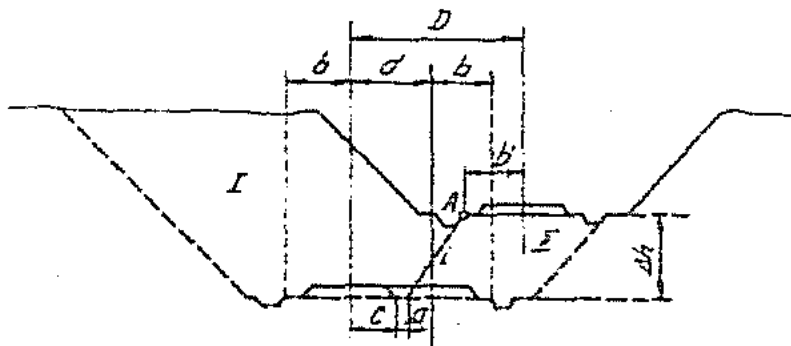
Dublarea liniei în debleu cu rectificarea axei liniei existente în plan și în profil
